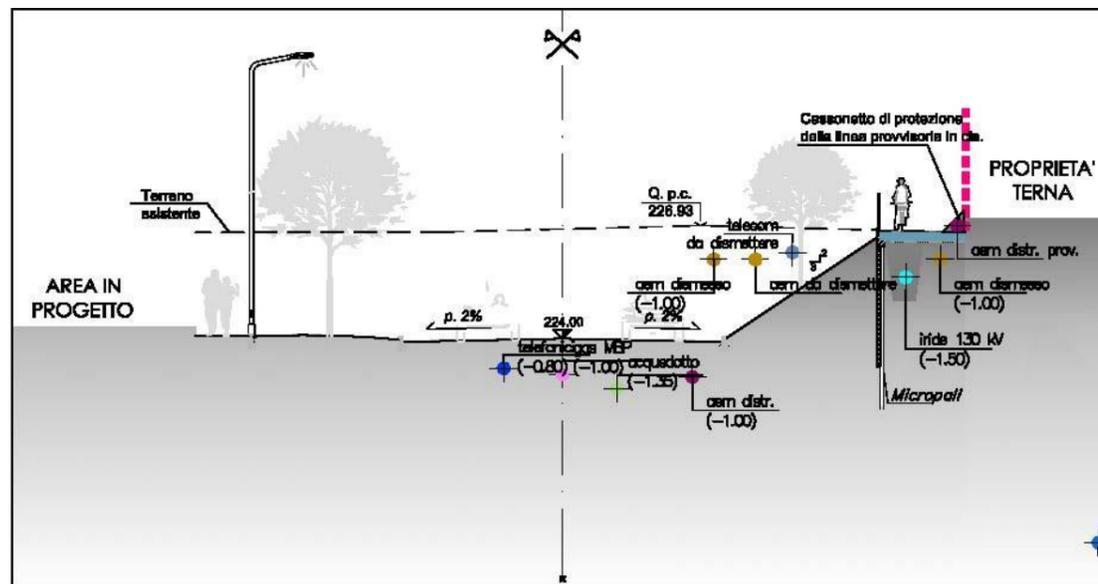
Strada Basse di Stura sez.5 – PROGETTO
